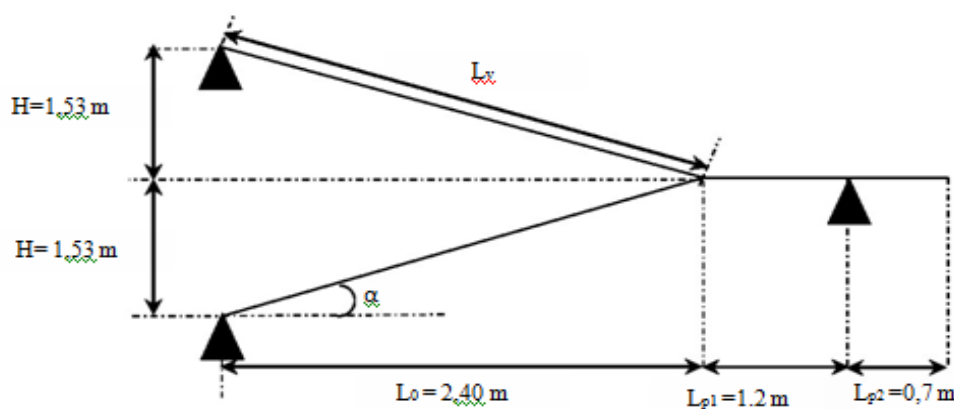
Coupe en élévation de l'escalier droit à deux volées
